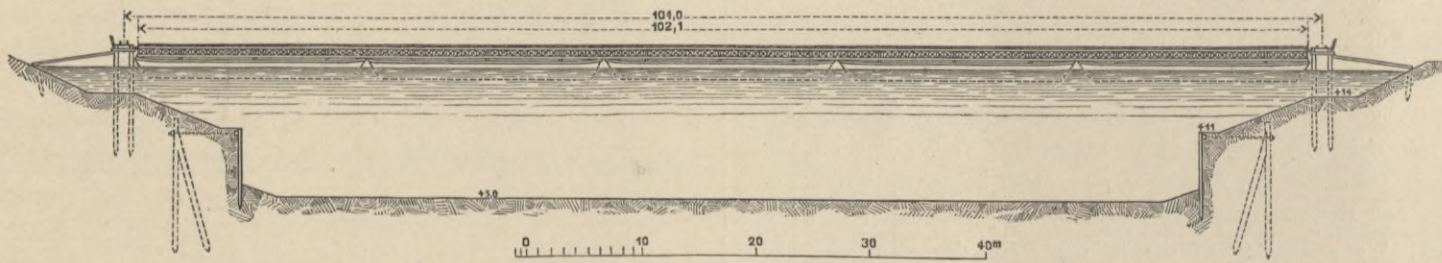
Querschnitt durch die Baugrube und Ansicht der Schwimmbrücke.
